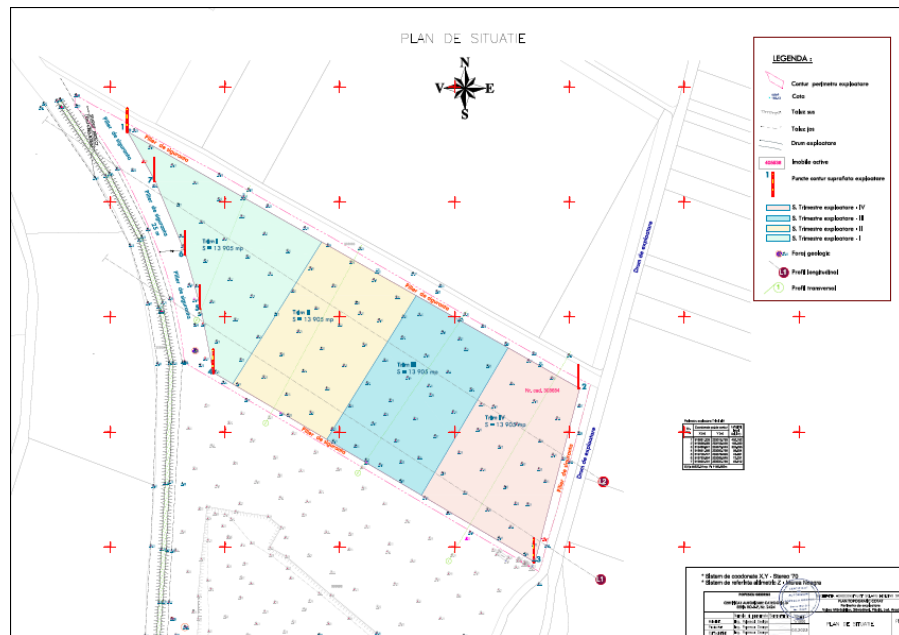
Plan de situație teren identificat prin CF. 308684
